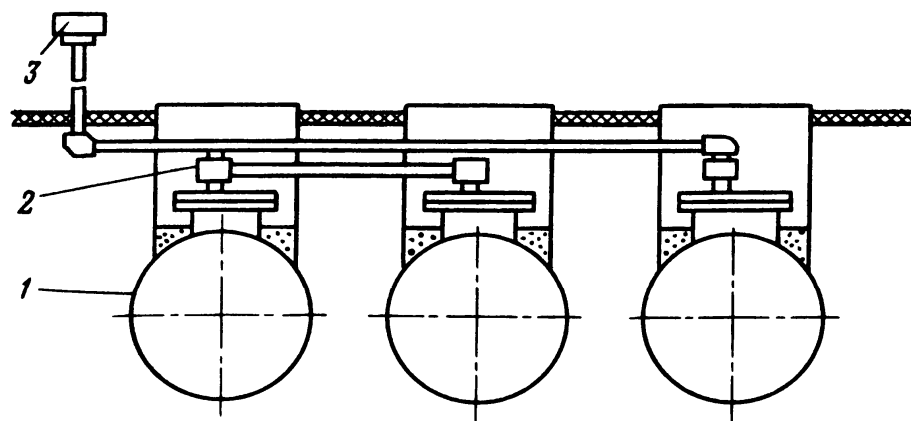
Схема газовой обвязки резервуаров АЗС:
